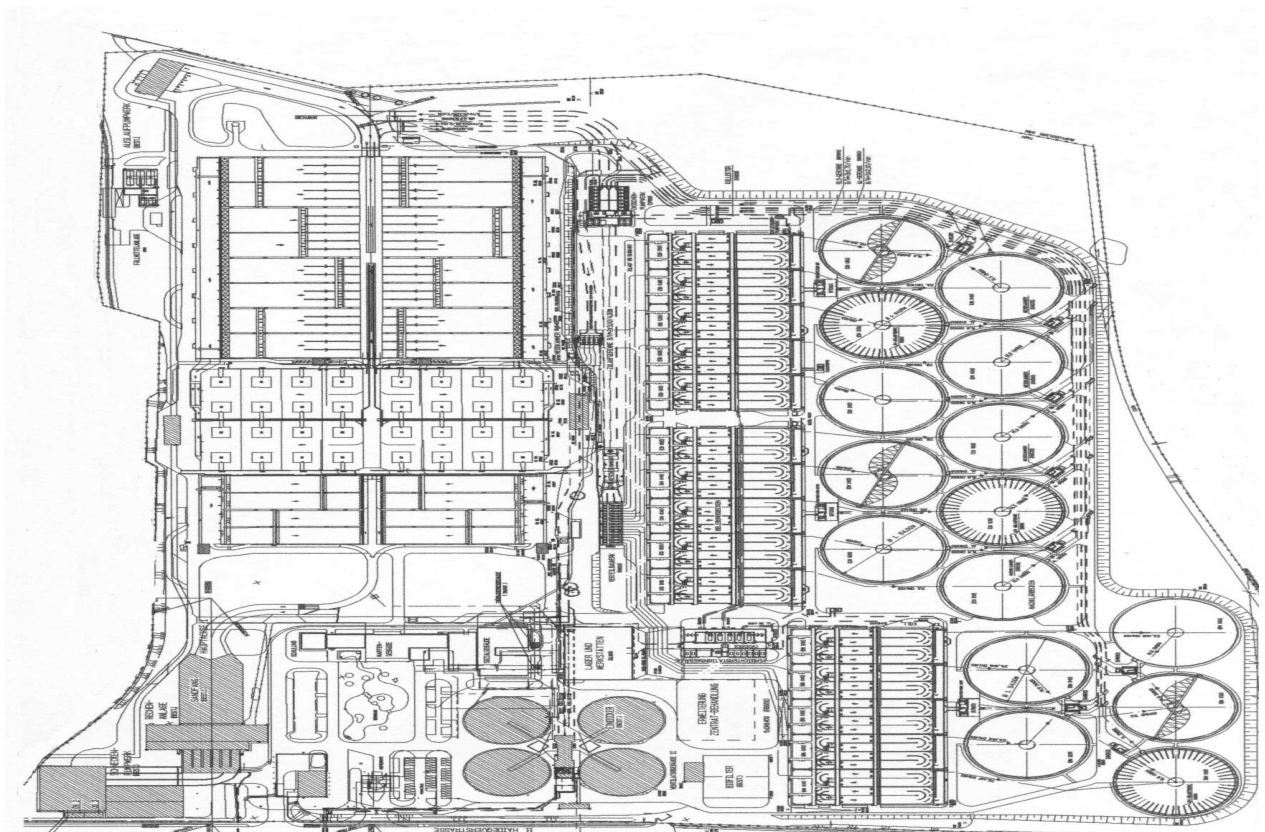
Lageplan Erweiterung der Hauptkläranlage (2000)
